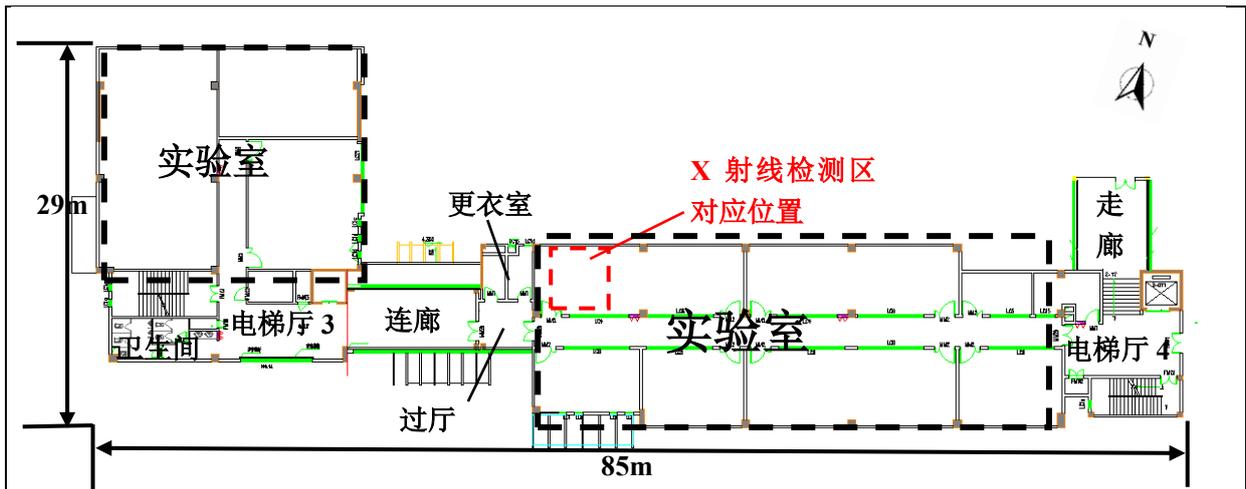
2 号楼和 3 号楼 2 层平面布置图
